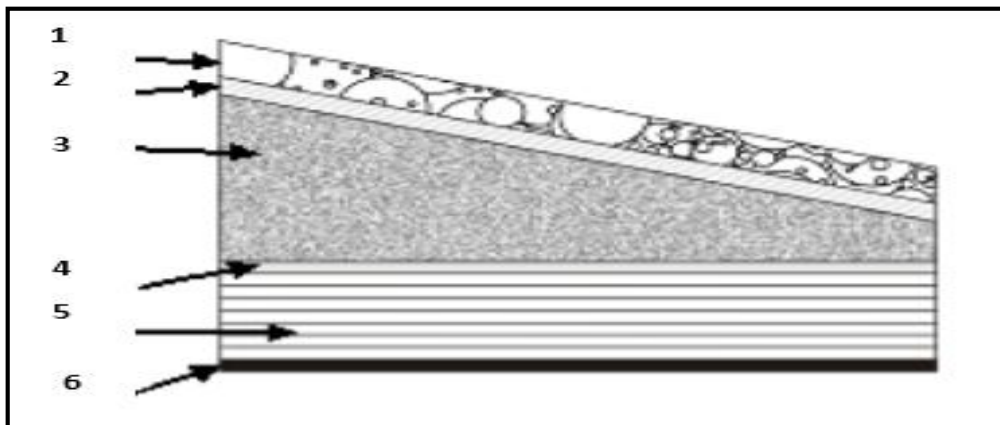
les éléments de plancher terrasse des dalles pleines
